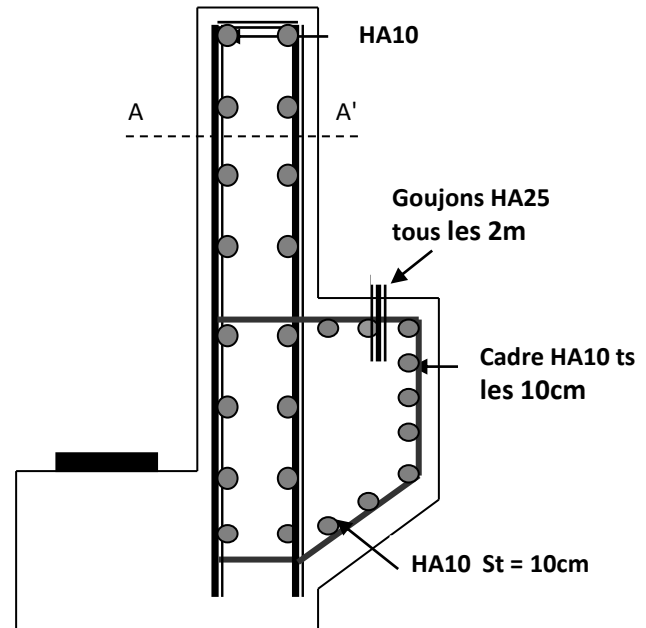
Ferrailage du mur garde grève et du corbeau d'appui.
